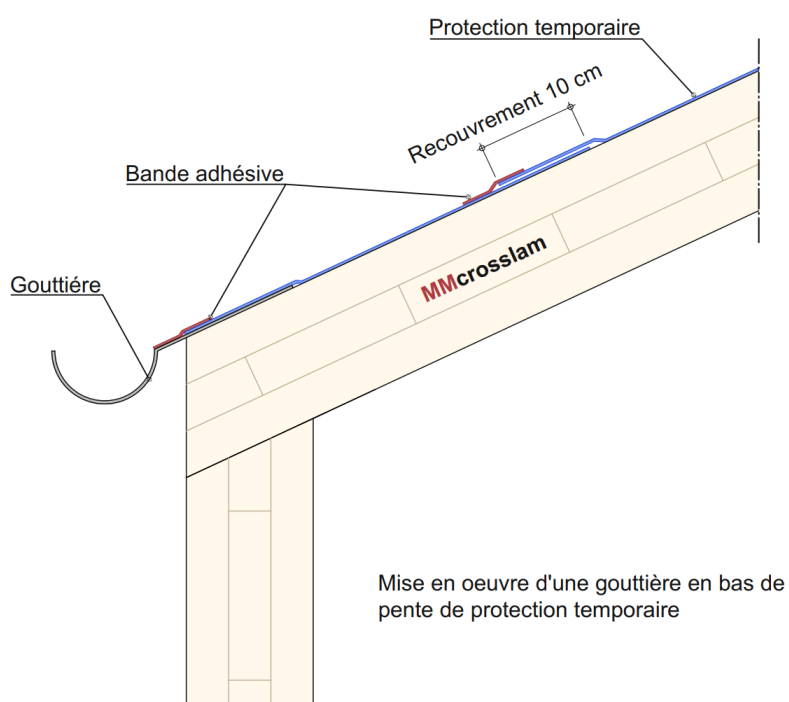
Mise en œuvre d'une gouttière en bas de pente de protection temporaire
